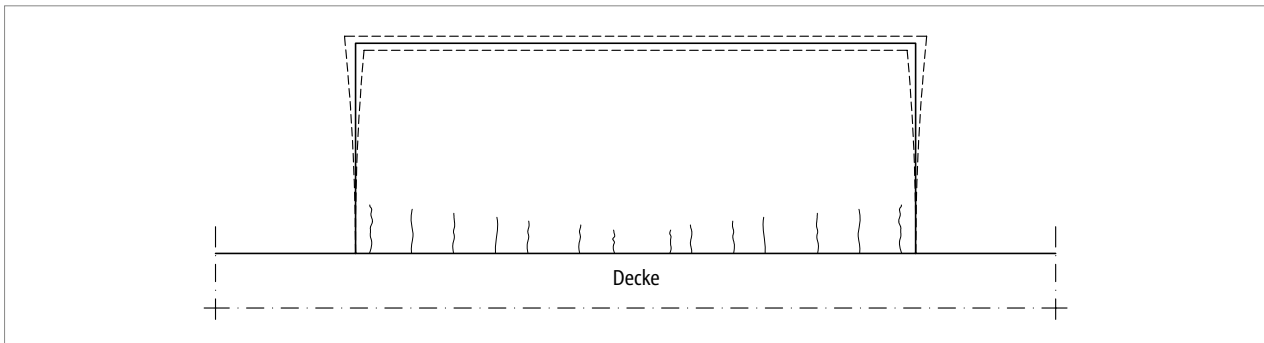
Balkonplatte ohne Schöck Isokorb®: Rissbildung durch Ermüdung möglich
